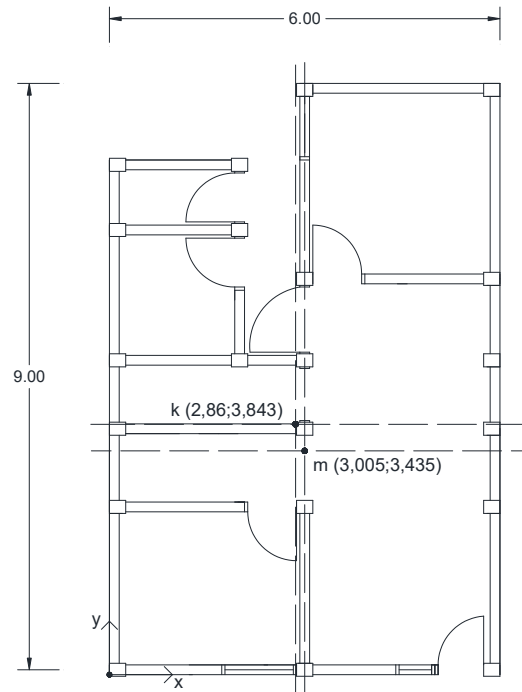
Penomoran dinding denah tipe 45 extension.
